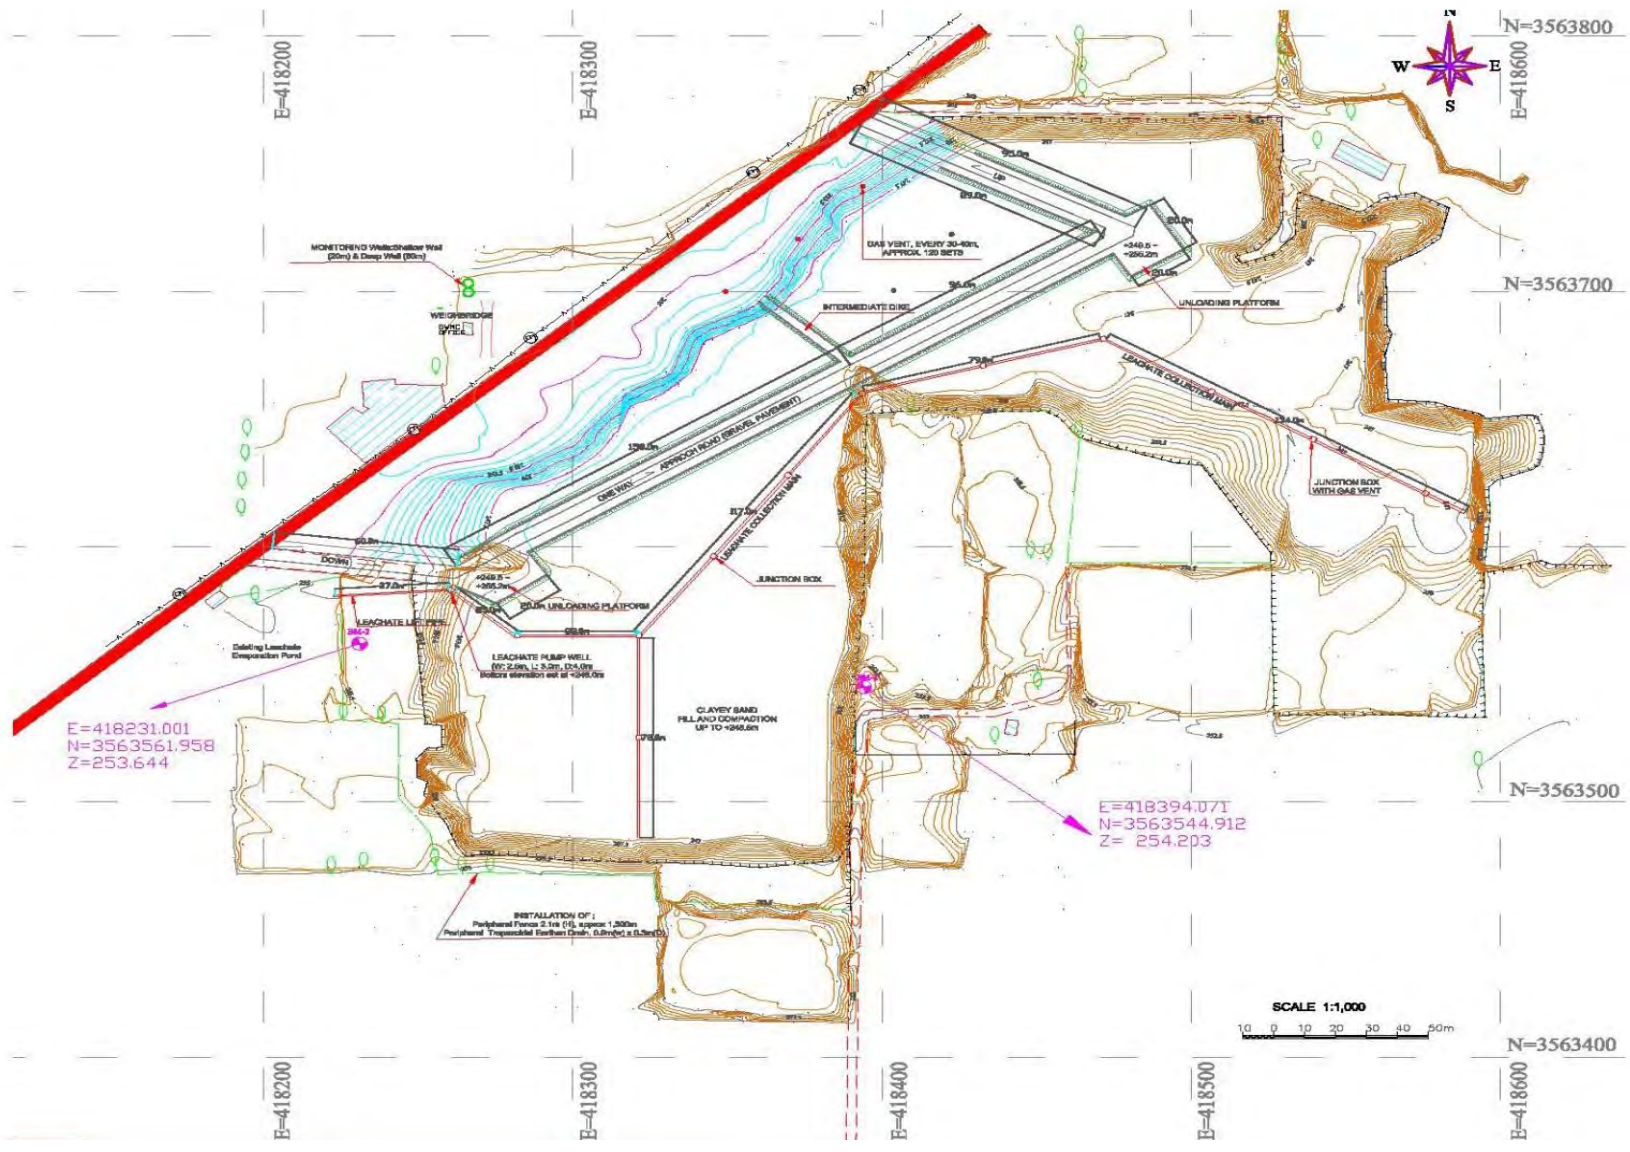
ゴンドランワラ処分場改善工事の計画平面図
